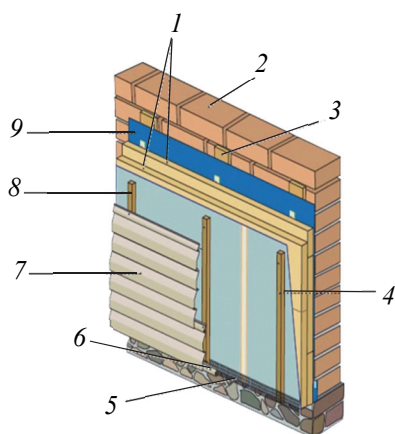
Схема вентилируемого фасада ограждающей конструкции из кирпича с утеплением плитами из древесного волокна Белтермо:
